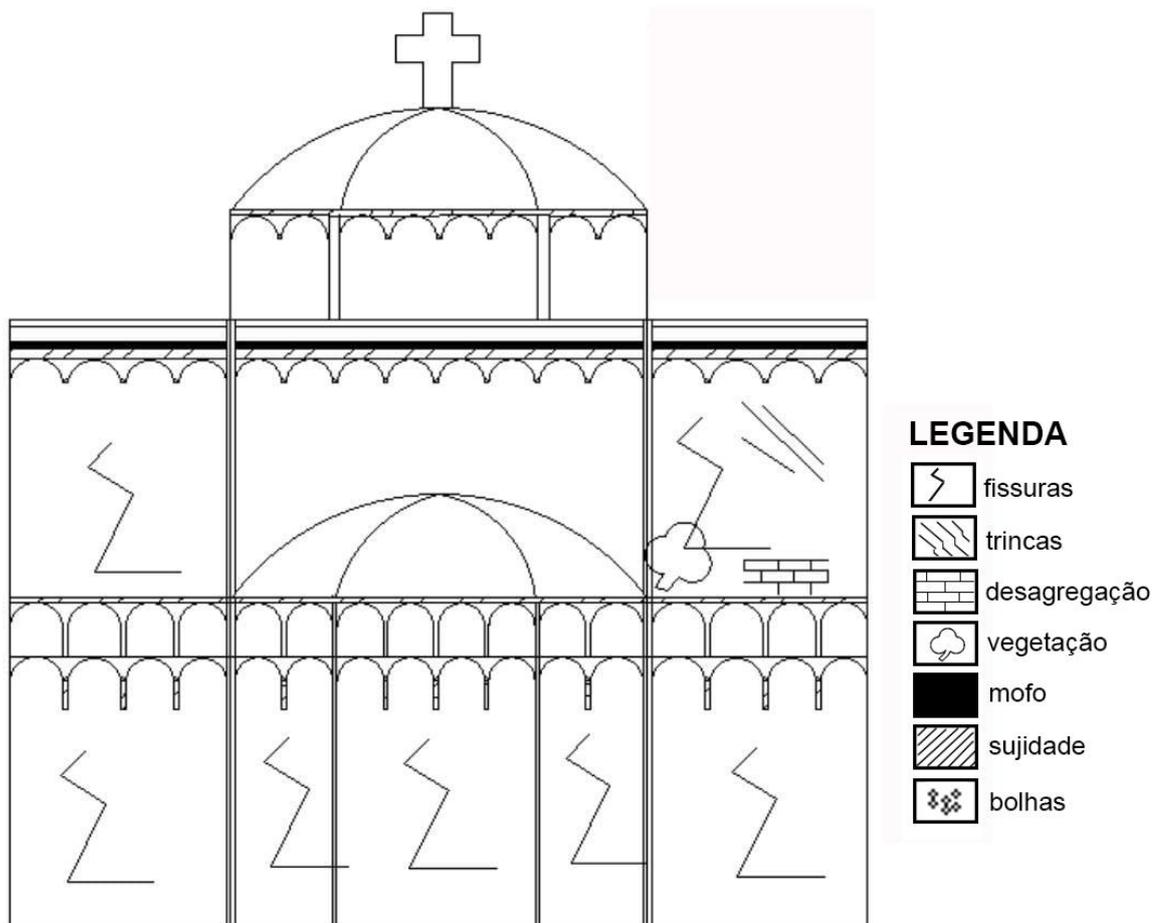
Fissuras, trinca, sujidades, desagregação e presença de vegetação presentes na Fachada Sudoeste da edificação (Vista Traseira)
